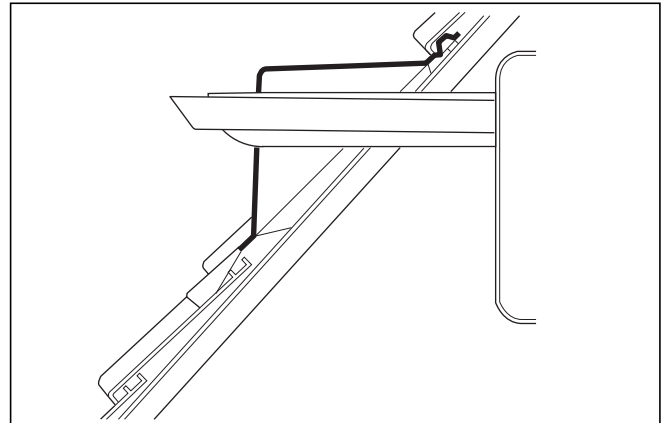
Пример монтажа горизонтального кровельного ввода (слуховое окно)
